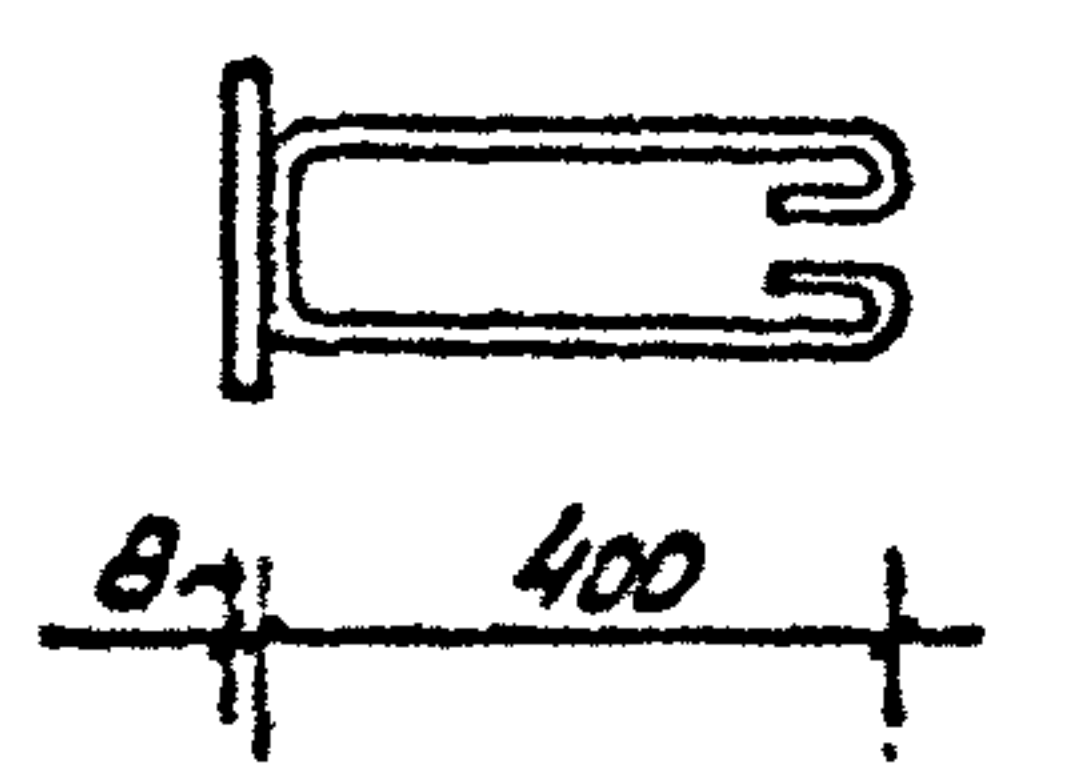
Закладные детали в железобетонных колоннах для крепления подкрановых балок
